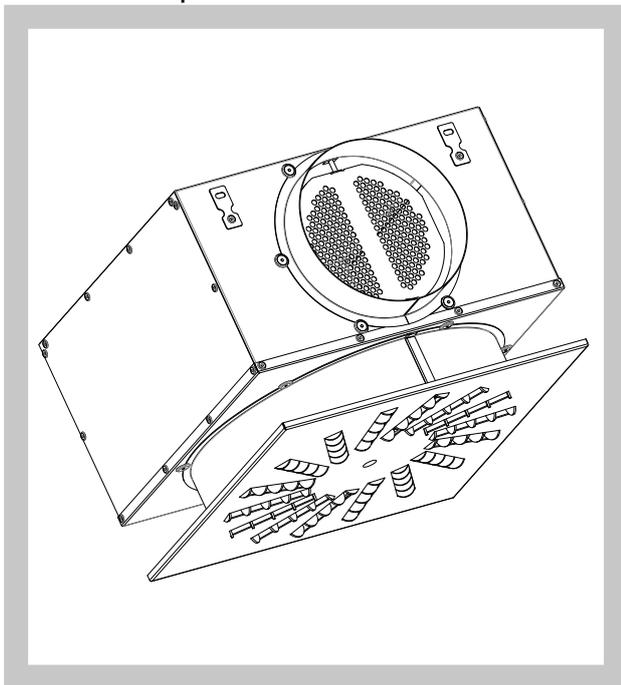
VVM mit Anschlusskasten - Runde Frontplatte
